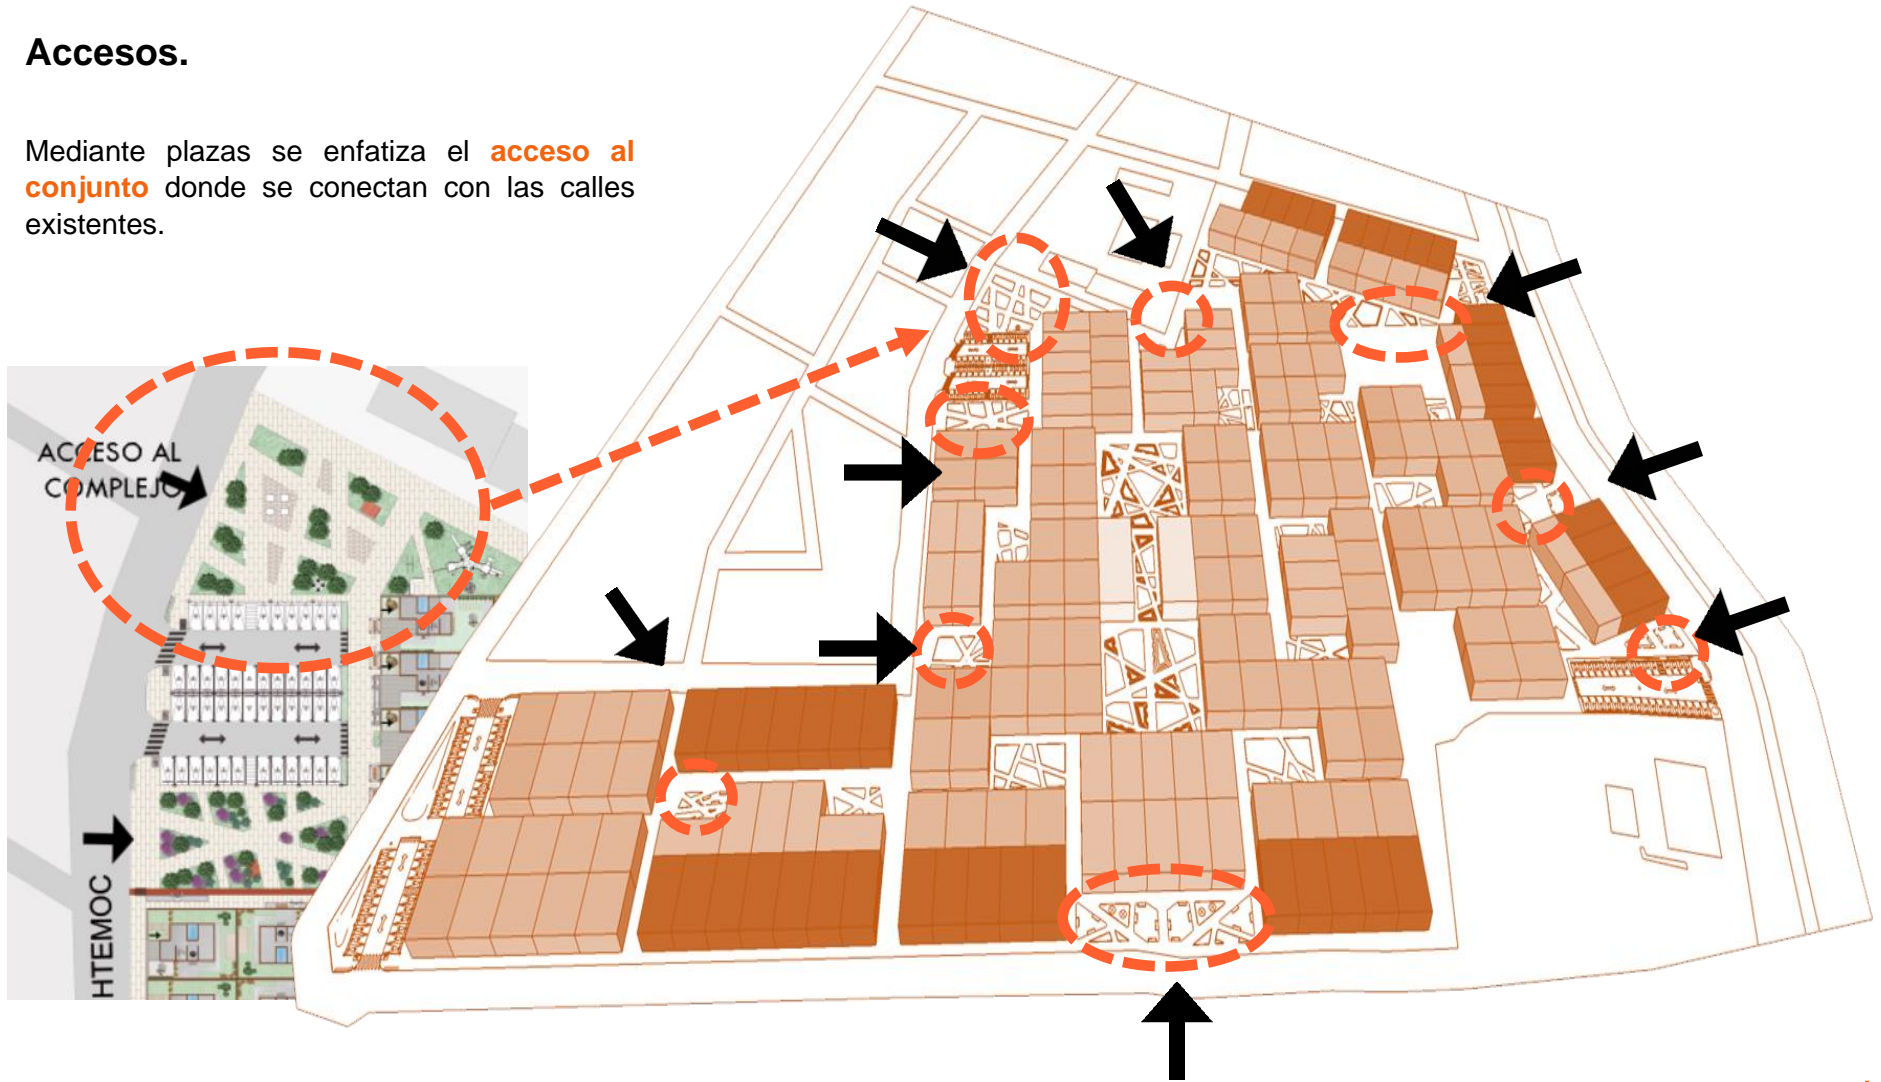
Plazas de acceso al Conjunto Habitacional. Plano de elaboración propia, 2017.
